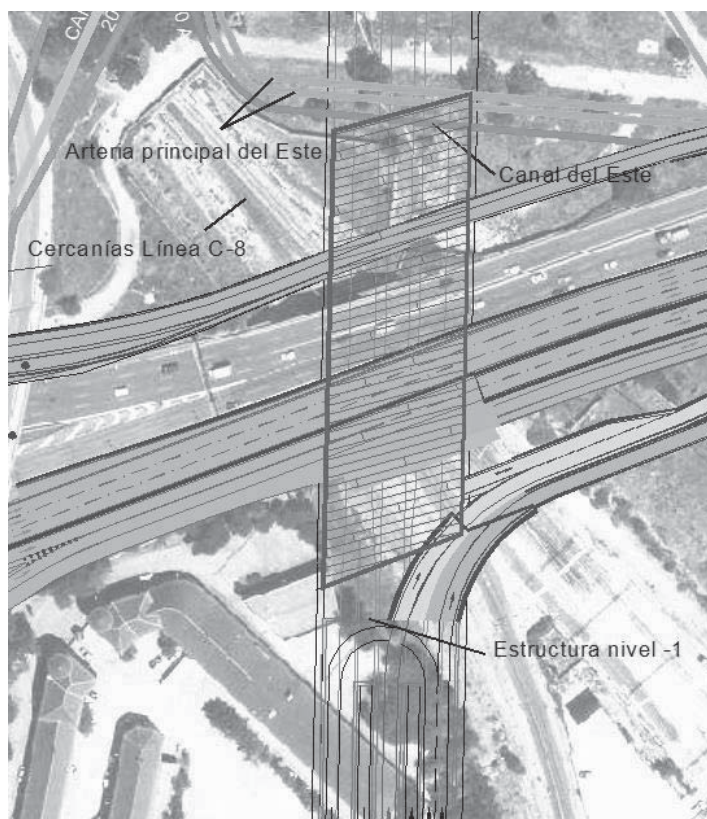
Ubicación en planta del puente de Agustín de Foxá sobre la Calle 30 e infraestructuras afectadas
